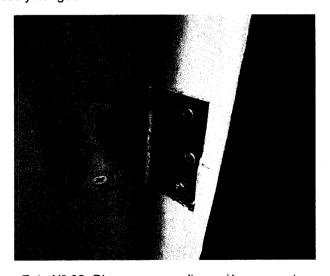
Bisagra menor dimensión en puerta de acceso
